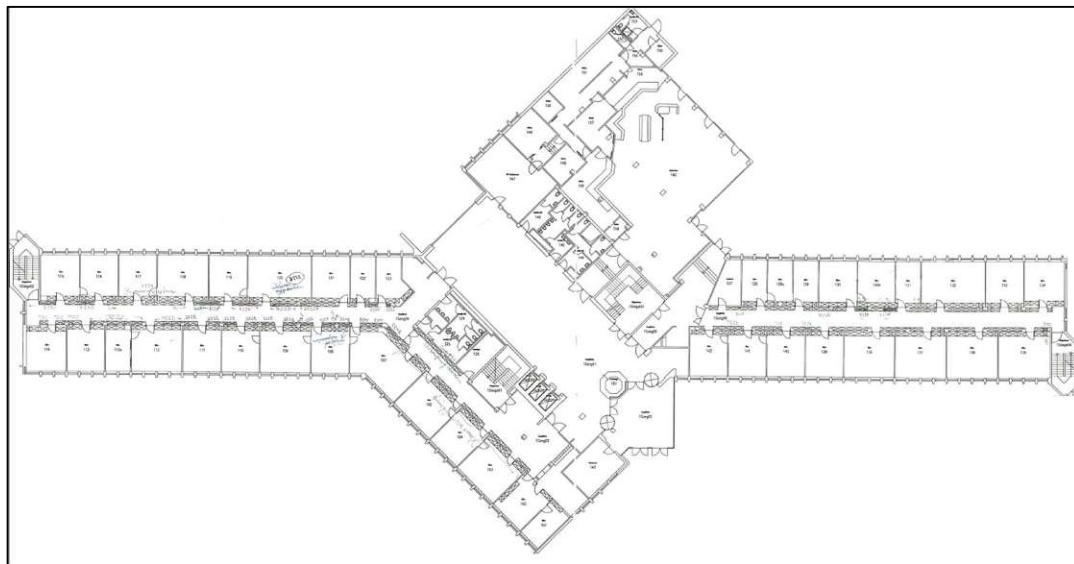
Grundriss Grellgasse Bürogebäude
